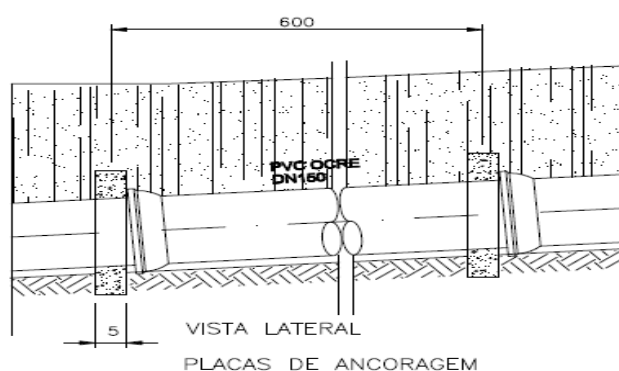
Vista Lateral de ancoragem em placas de concreto armado moldada *in loco*.
